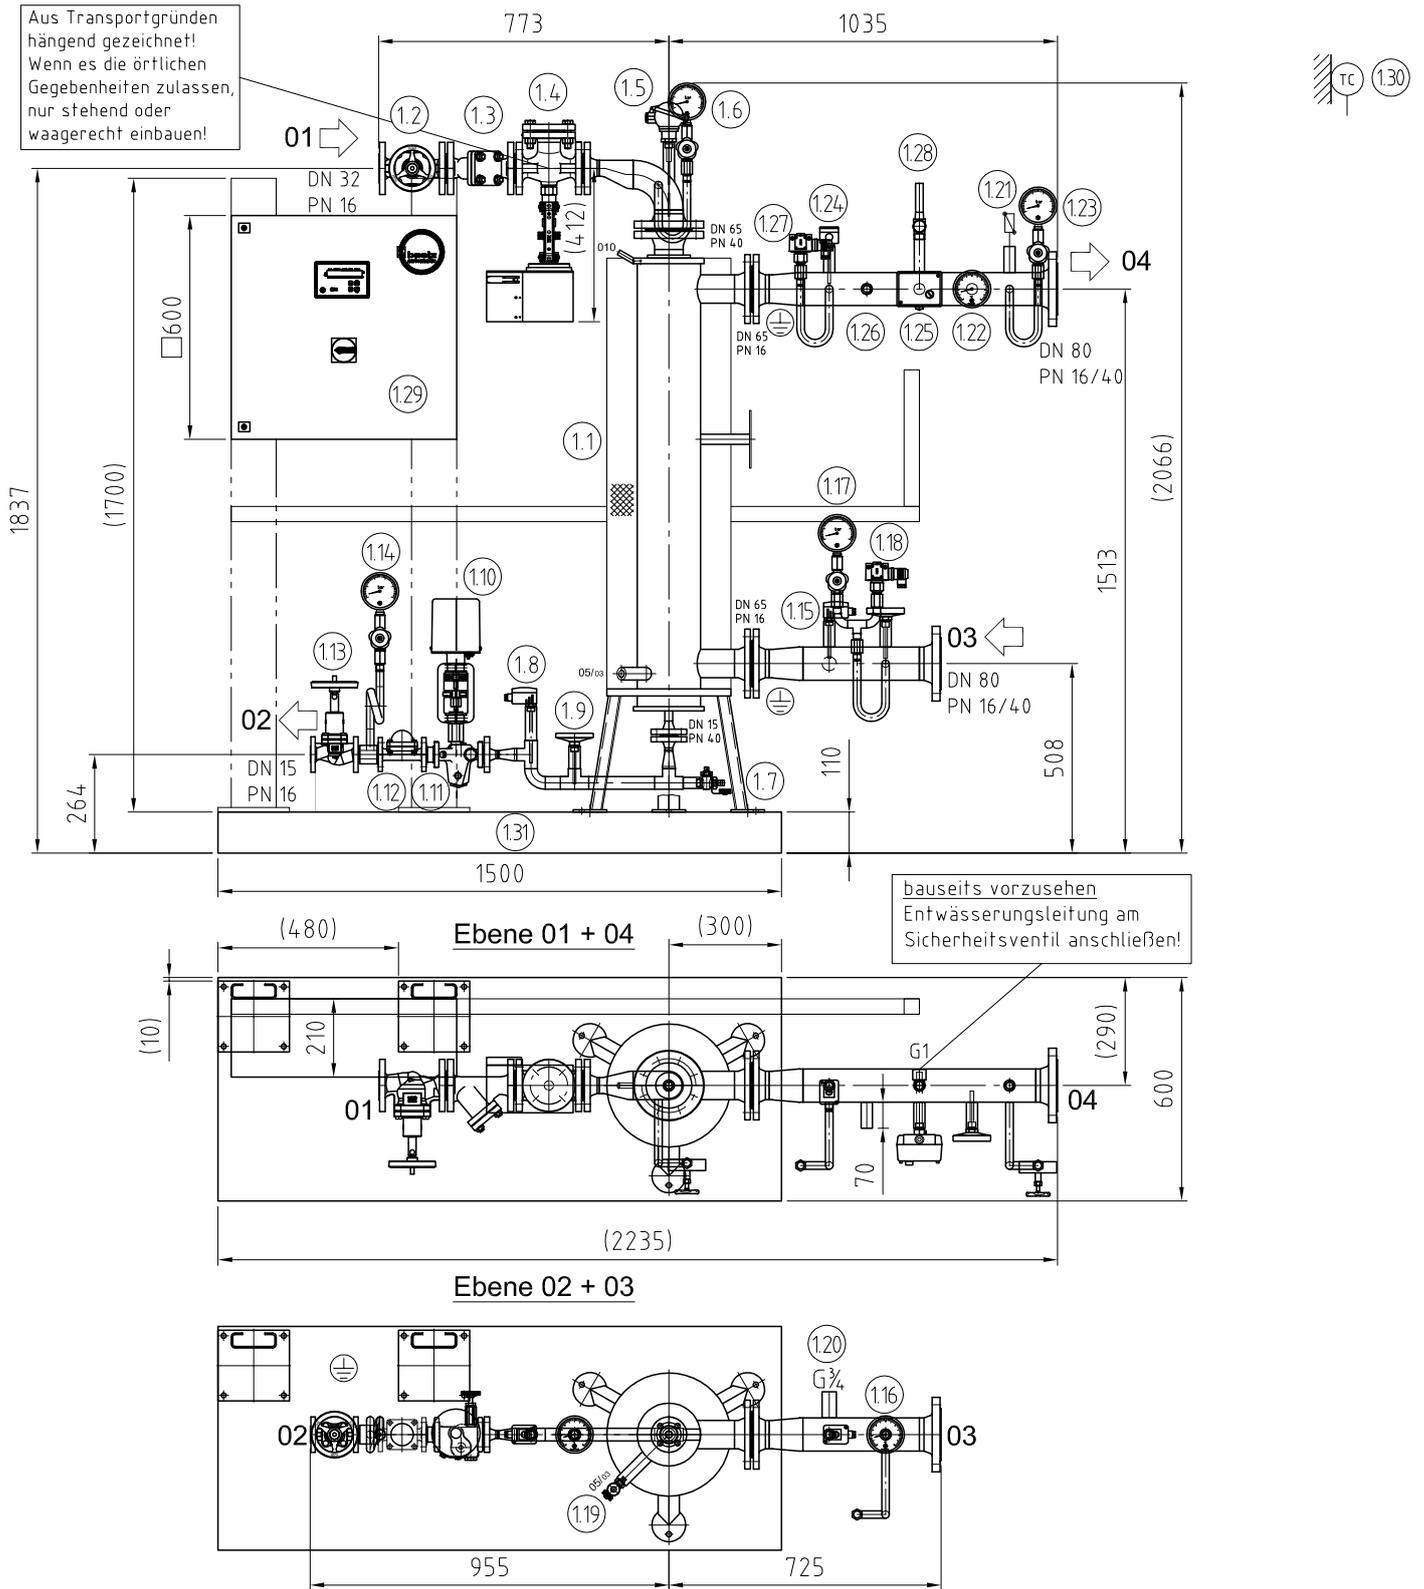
Beispiel-Montageplan Steam Terminal "Luxese Instant Heat" mit baelz 106
